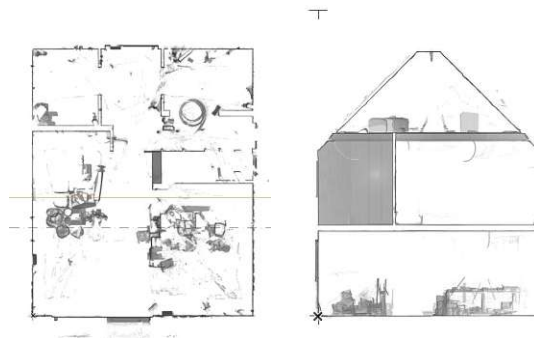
Basis Grundriss (li.) und Schnitt (re.) für die Orientierung in Archicad.
